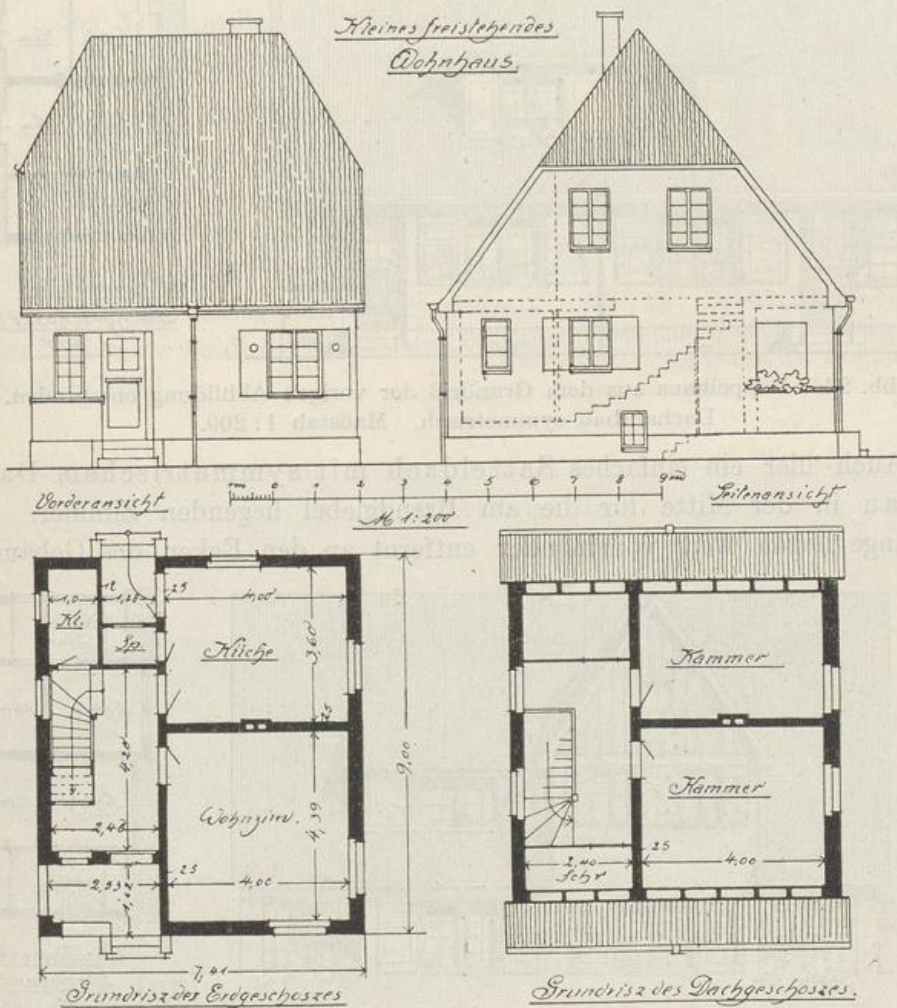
Kleines freistehendes Arbeiter-Wohnhaus mit Wohnzimmer, Küche und Zubehör im Erdgeschoß, 2 Kammern und Zubehör im Dachgeschoß. Treppe am Giebel, daher keine Dachaufbauten.
